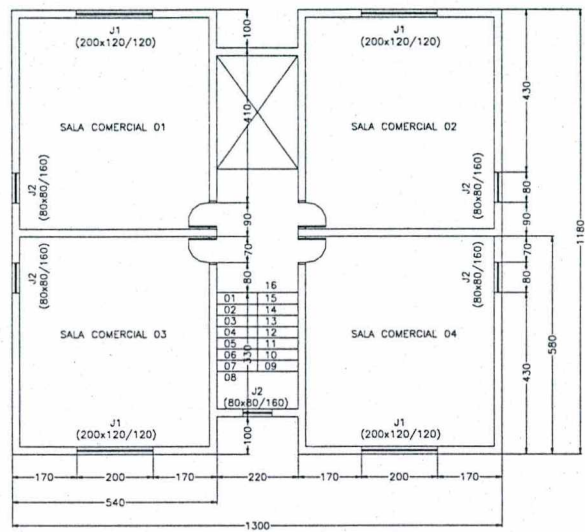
Planta baixa do pavimento tipo dos edifícios dos exemplos 1a e 1b
